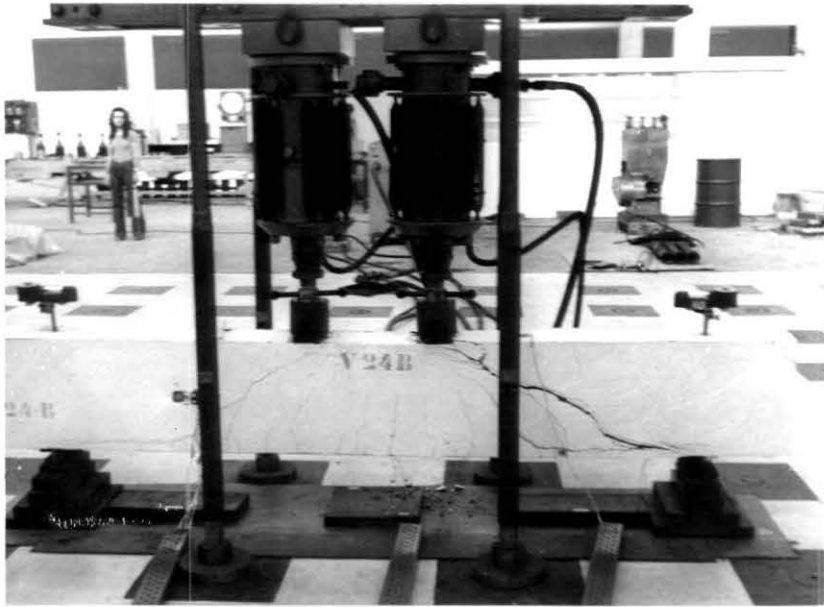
Vista geral da viga 24B ($a/d=2,4$) rompida por esmagamento do concreto na zona comprimida, associado com perda parcial da ancoragem da armadura longitudinal.
